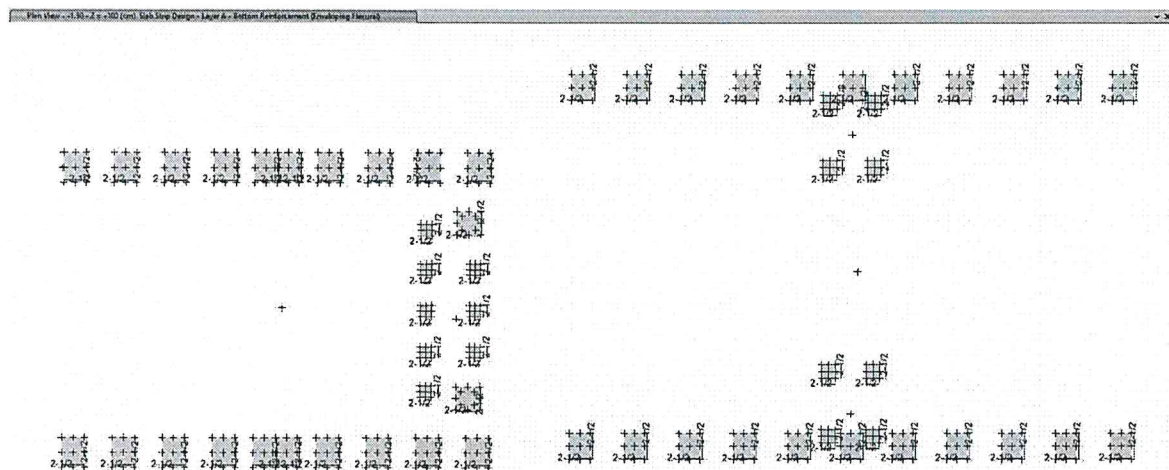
Vista en Planta - Edificación 19-20 - Diseño de Refuerzo Longitudinal y Transversal en las zapatas, calculando el Área (A_s) en cm^2 ; Calculado por el Programa ETABS Ultimate C 19.0.0.
